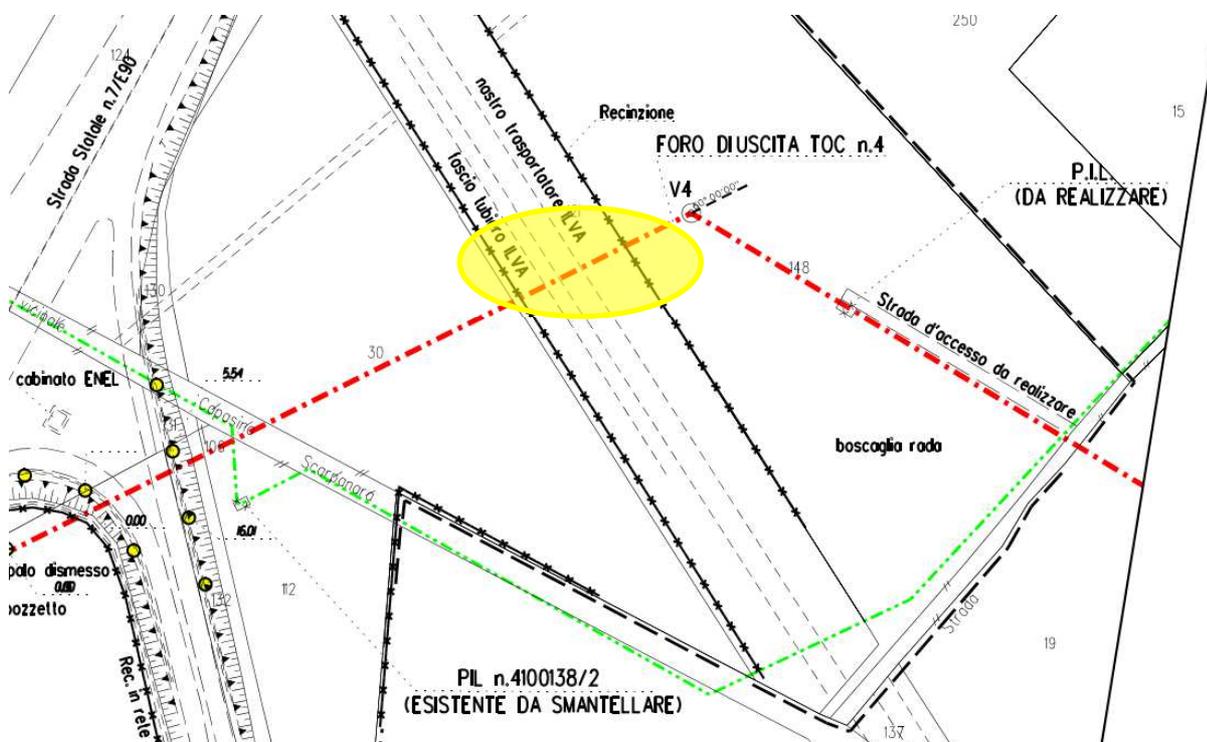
stralcio di planimetria catastale con individuazione del tratto in progetto in attraversamento al fascio tubiero ILVA
